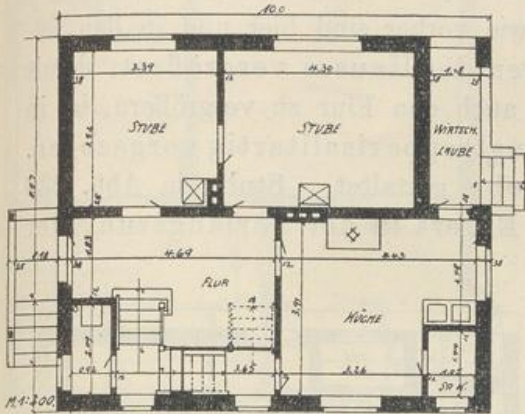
Hauseingang an der anderen Hausseite. Küche mit Spülmaschine, daneben Wirtschaftslaube mit Treppe nach dem Hof.
